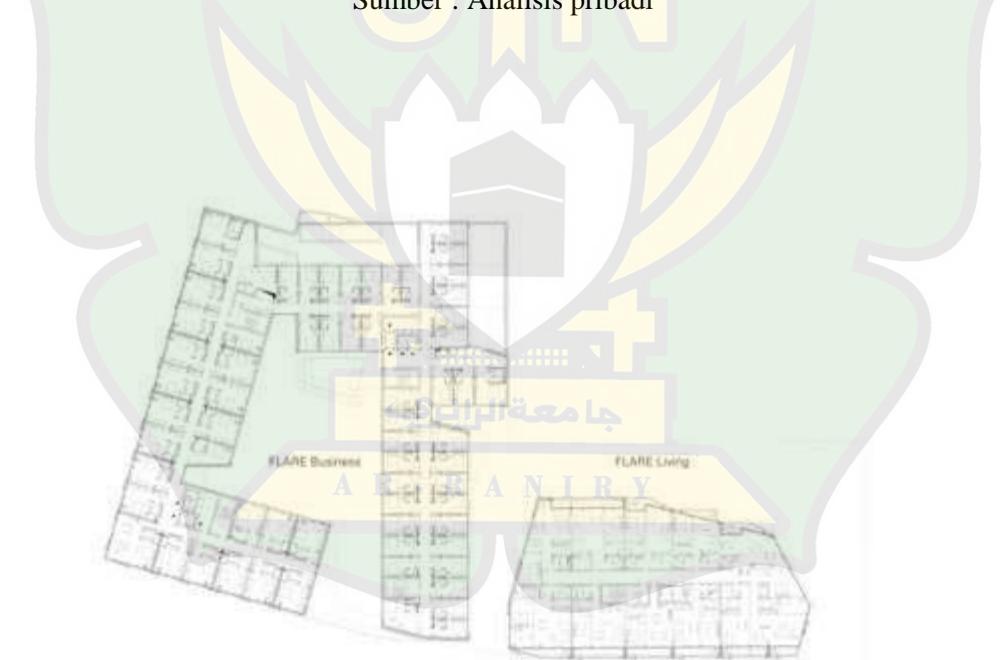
Denah lantai ke dua Flare of Frankfurt
